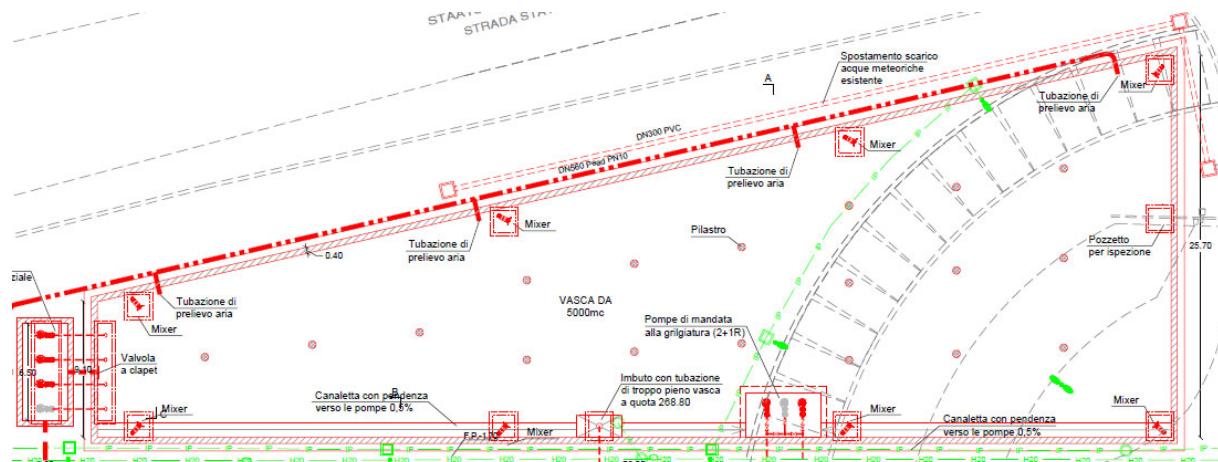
Grundriss Ausgleichbecken / planimetria vasca di omogenizzazione
